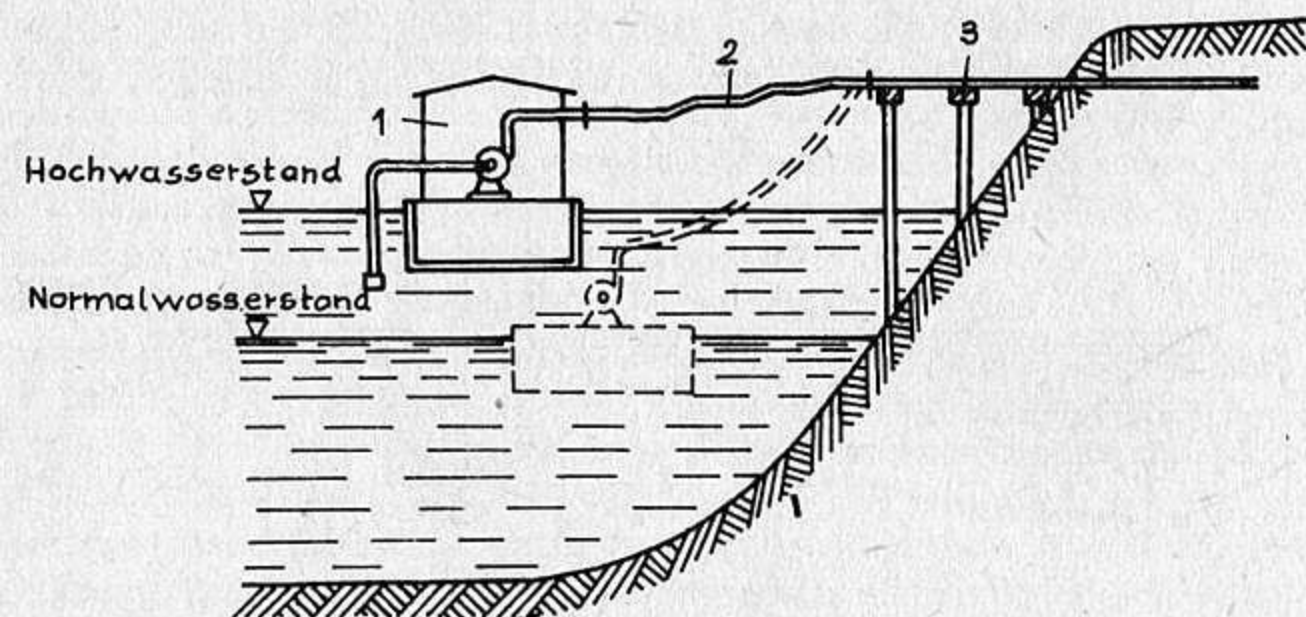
Wasserfassung mit schwimmendem Pumpwerk
